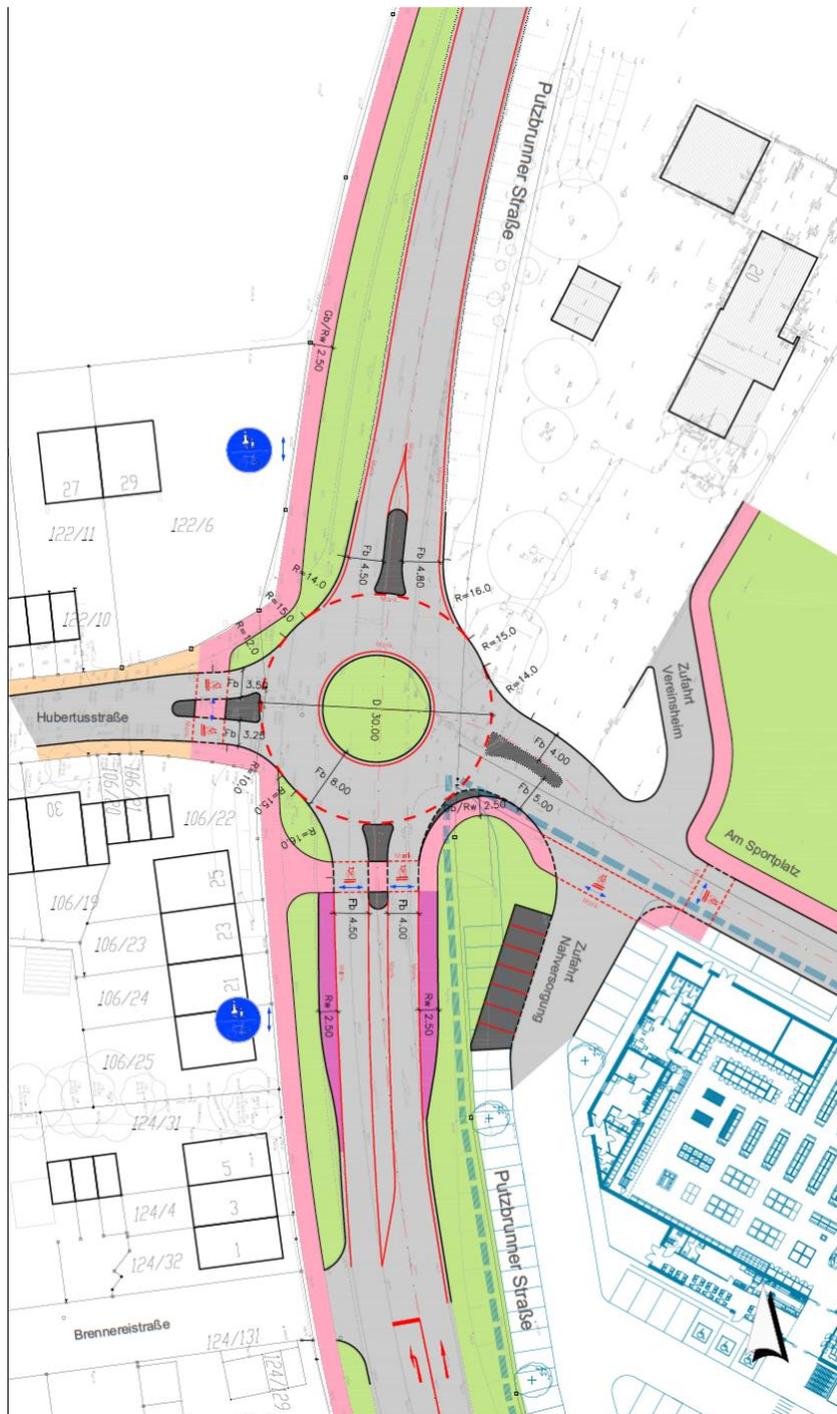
Lageplan Kreisverkehr Machbarkeitsstudie
